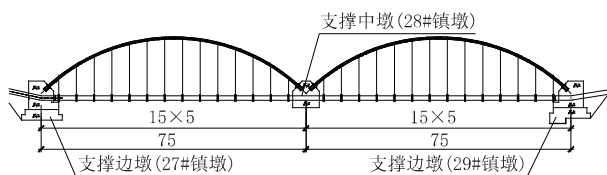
某下承式钢管系杆拱桥立面布置(单位:m)
